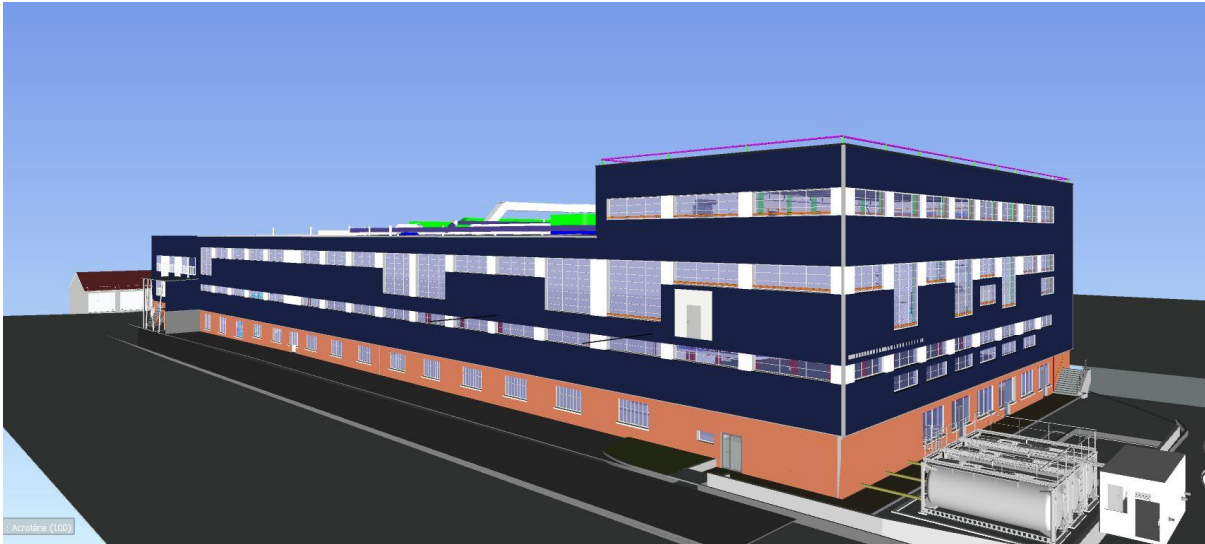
Projections 3D du site suite aux travaux de reconstruction
